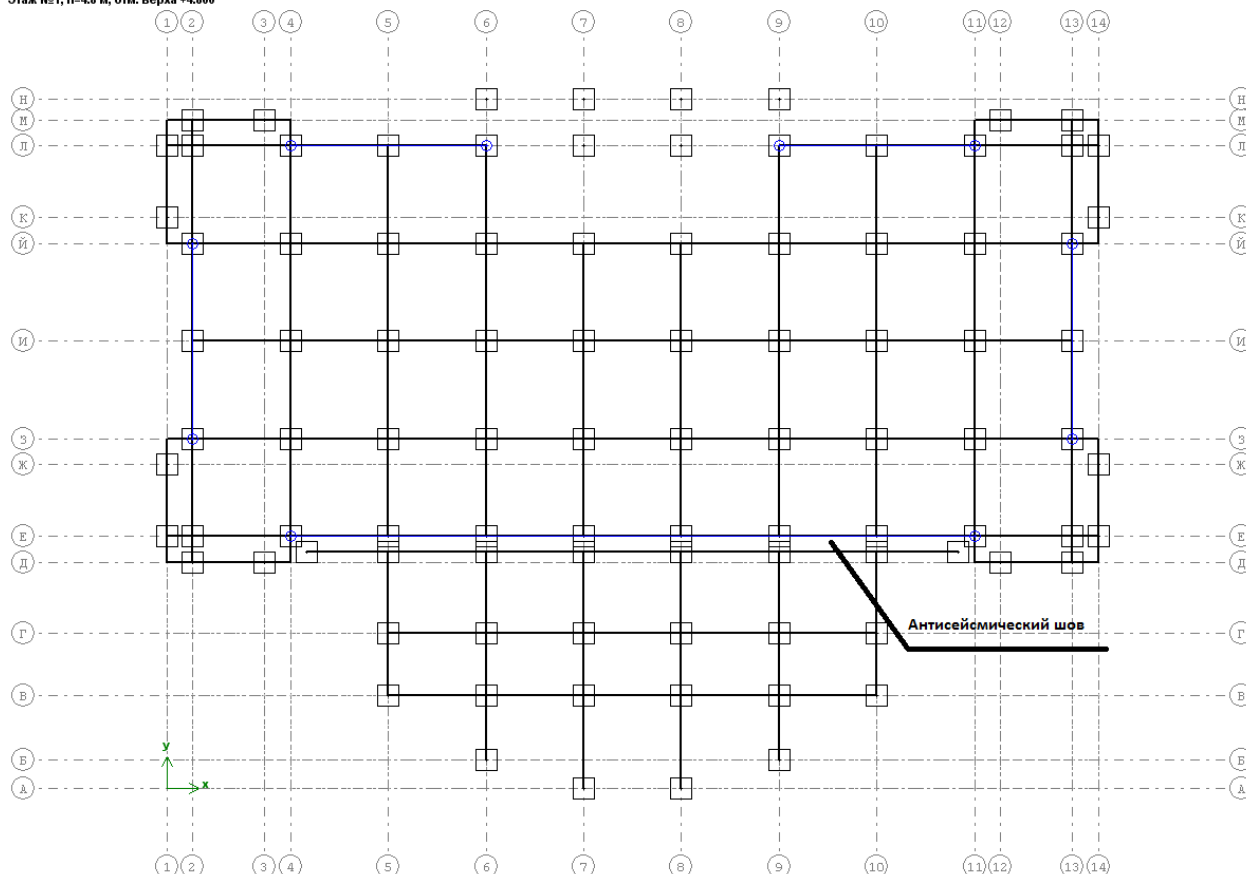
План несущих конструкций здания с антисейсмическим швом.
